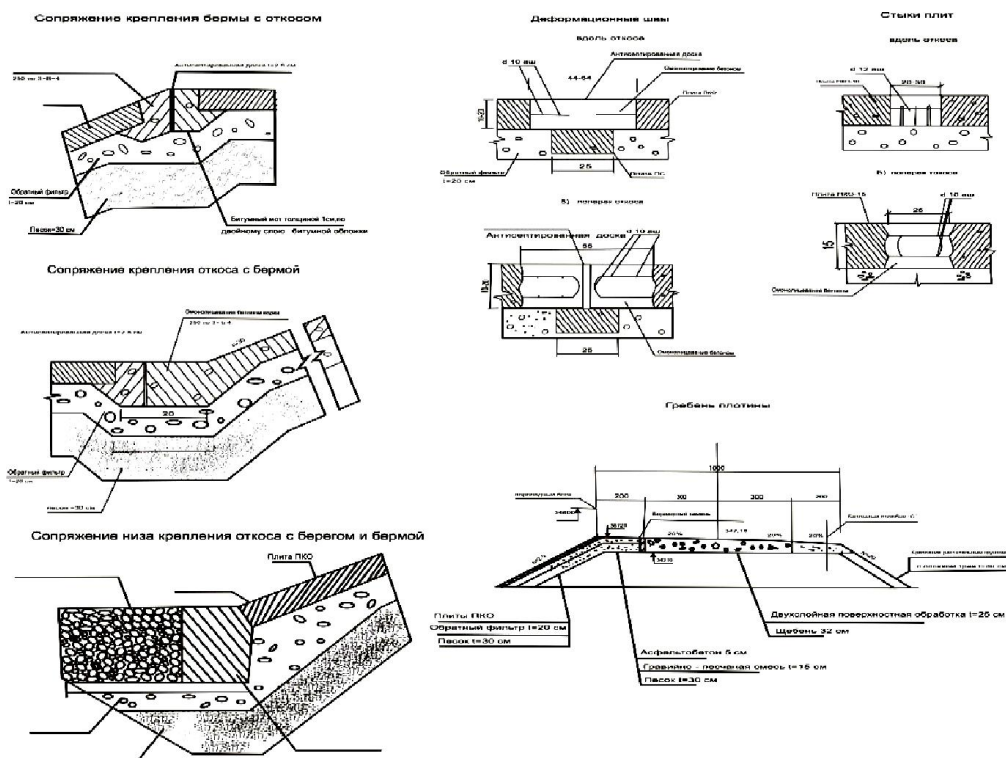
Конструкция крепления напорного откоса и гребень плотины.
